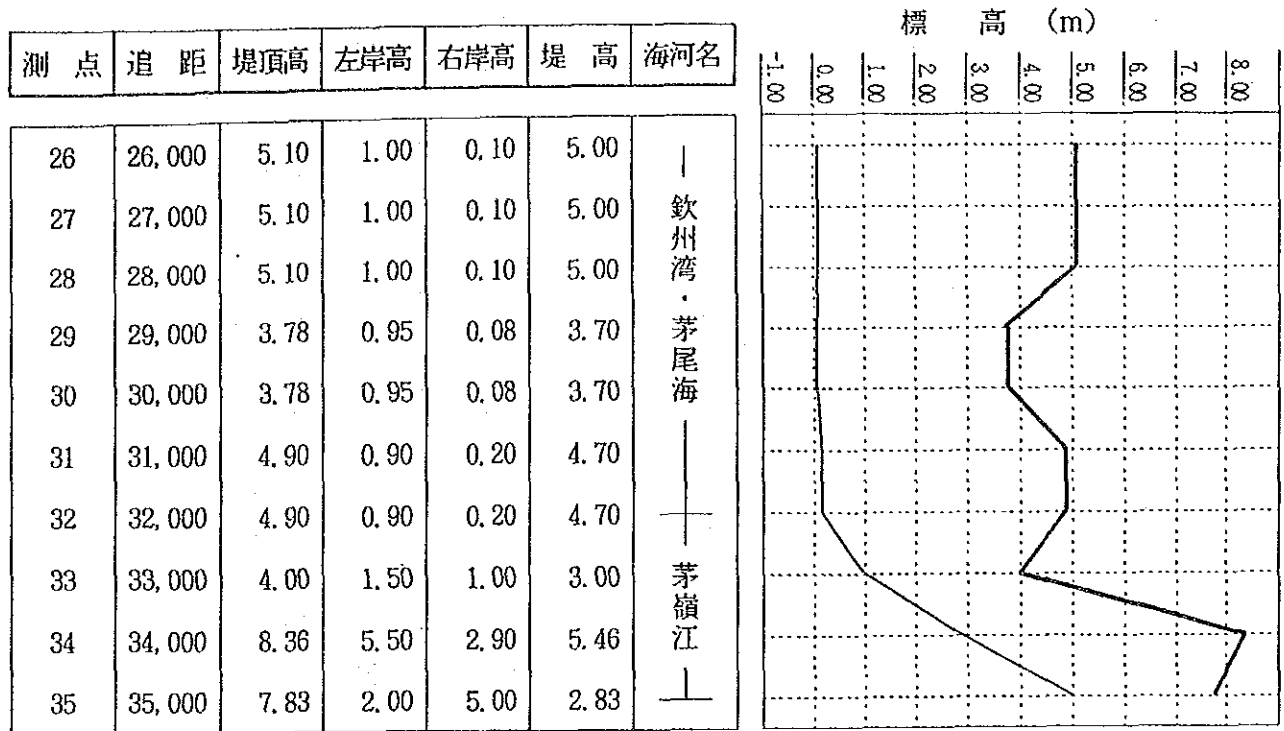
F-1.1-1 康輿県嶺田海河堤縦断面図 (その2/2)
